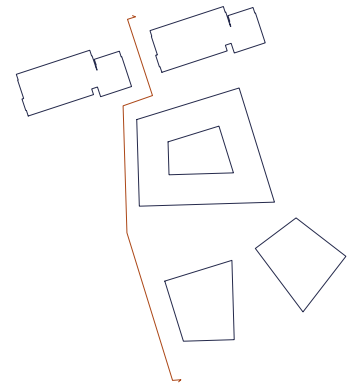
, Pianta piano secondo e terzo piano linea esistente.
